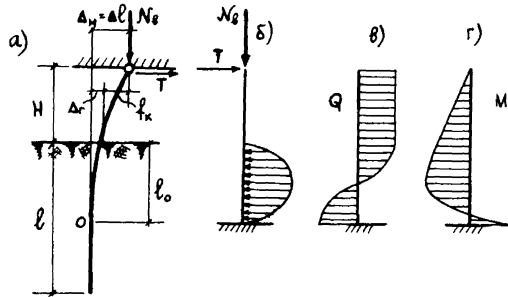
Схема взаимодействия свай при высоком достверке с шарнирной заделкой головы и грунта при горизонтальных перемещениях грунта $\Delta\ell$, вызванных подработкой: а- деформации свай и грунта; б- схема нагрузок на сваю; в- эпюра поперечных сил; г- эпюра изгибающих моментов; о- точка с нулевым прогибом свай (точка жесткой заделки свай в грунте).
